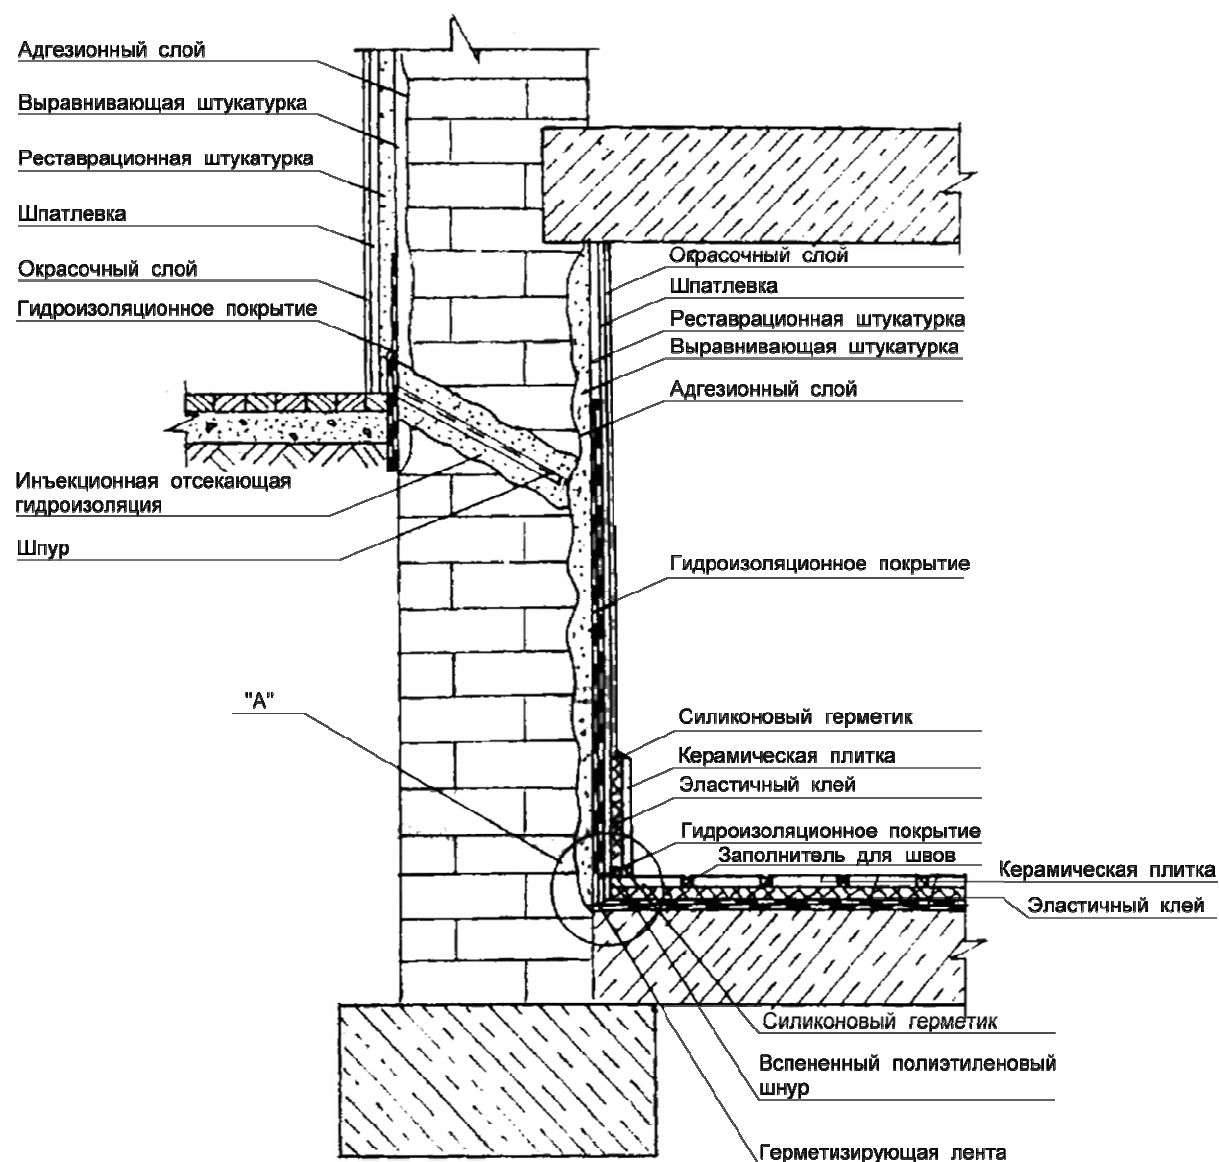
Внутренняя гидроизоляция фундаментов кальмирующими материалами
